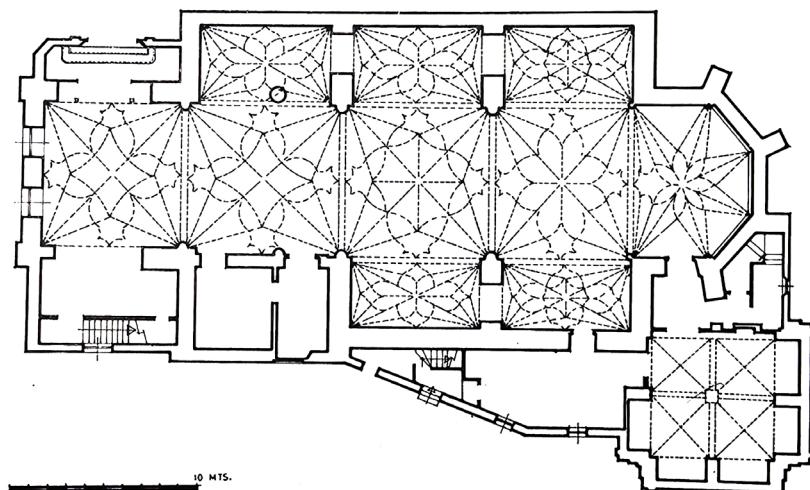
Planta de la iglesia parroquial de Milagro (García et al. 1985, 208).
